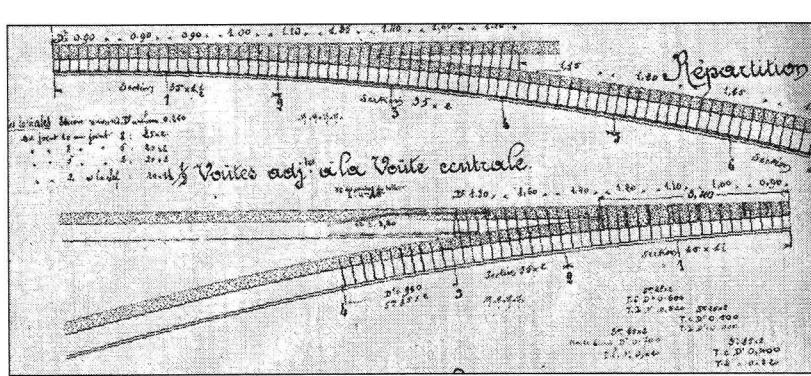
アーチの配筋を示す縦断面図（上：側径間、下：中央径間）
